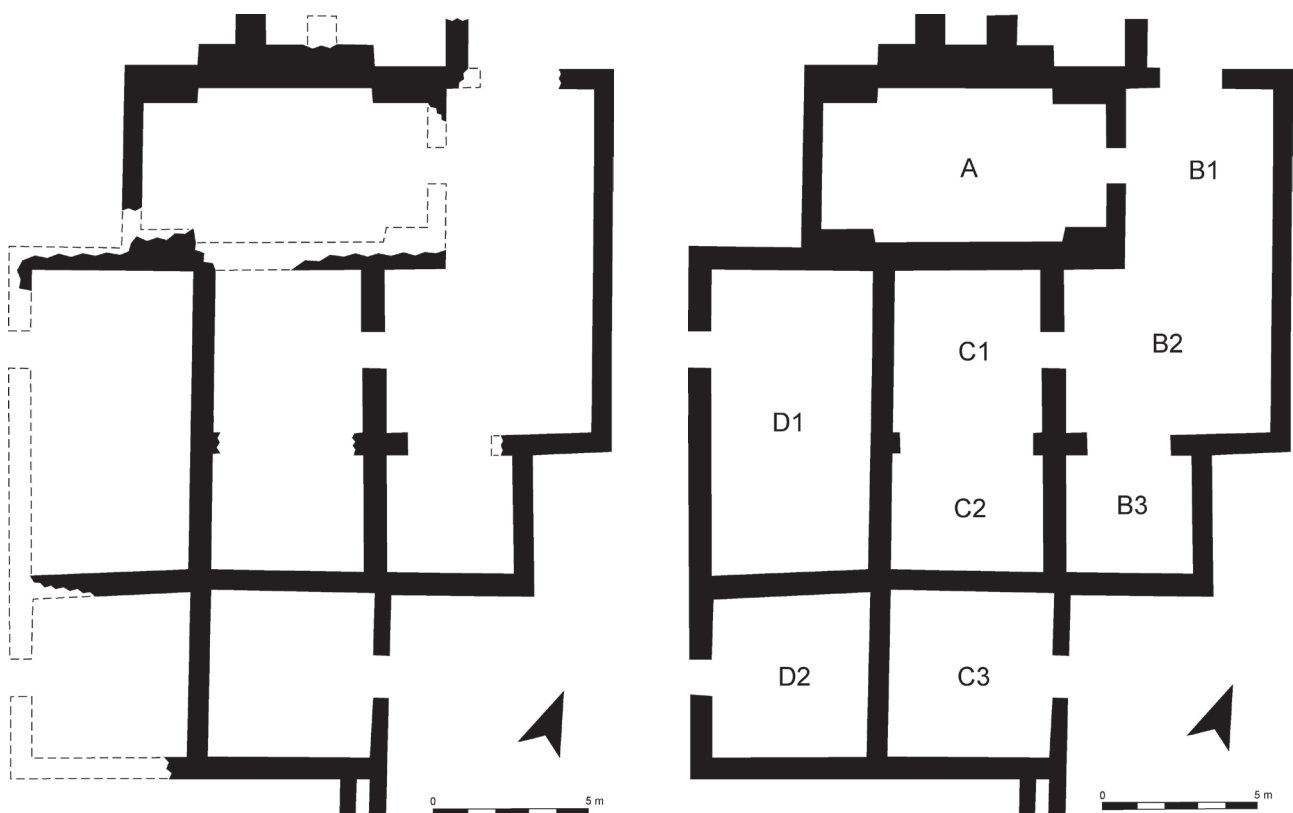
A) Planta de l'edifici parcialment excavat en 1986-87 al sector I. B) Divisió dels espais interiors sobre la planta restituida.
